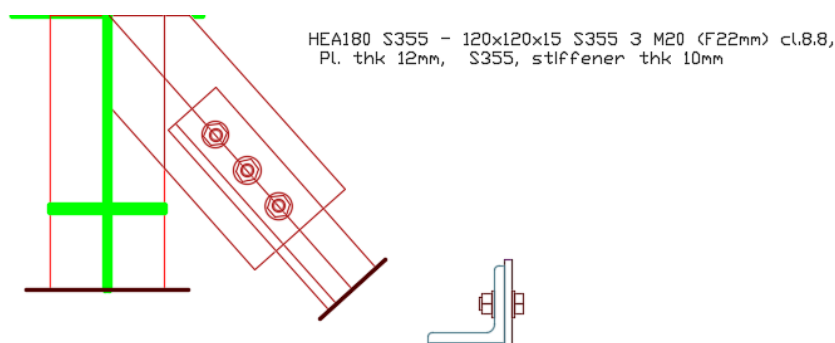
Ligação aparafusada da diagonal L 120x15 ao montante HEA 180
